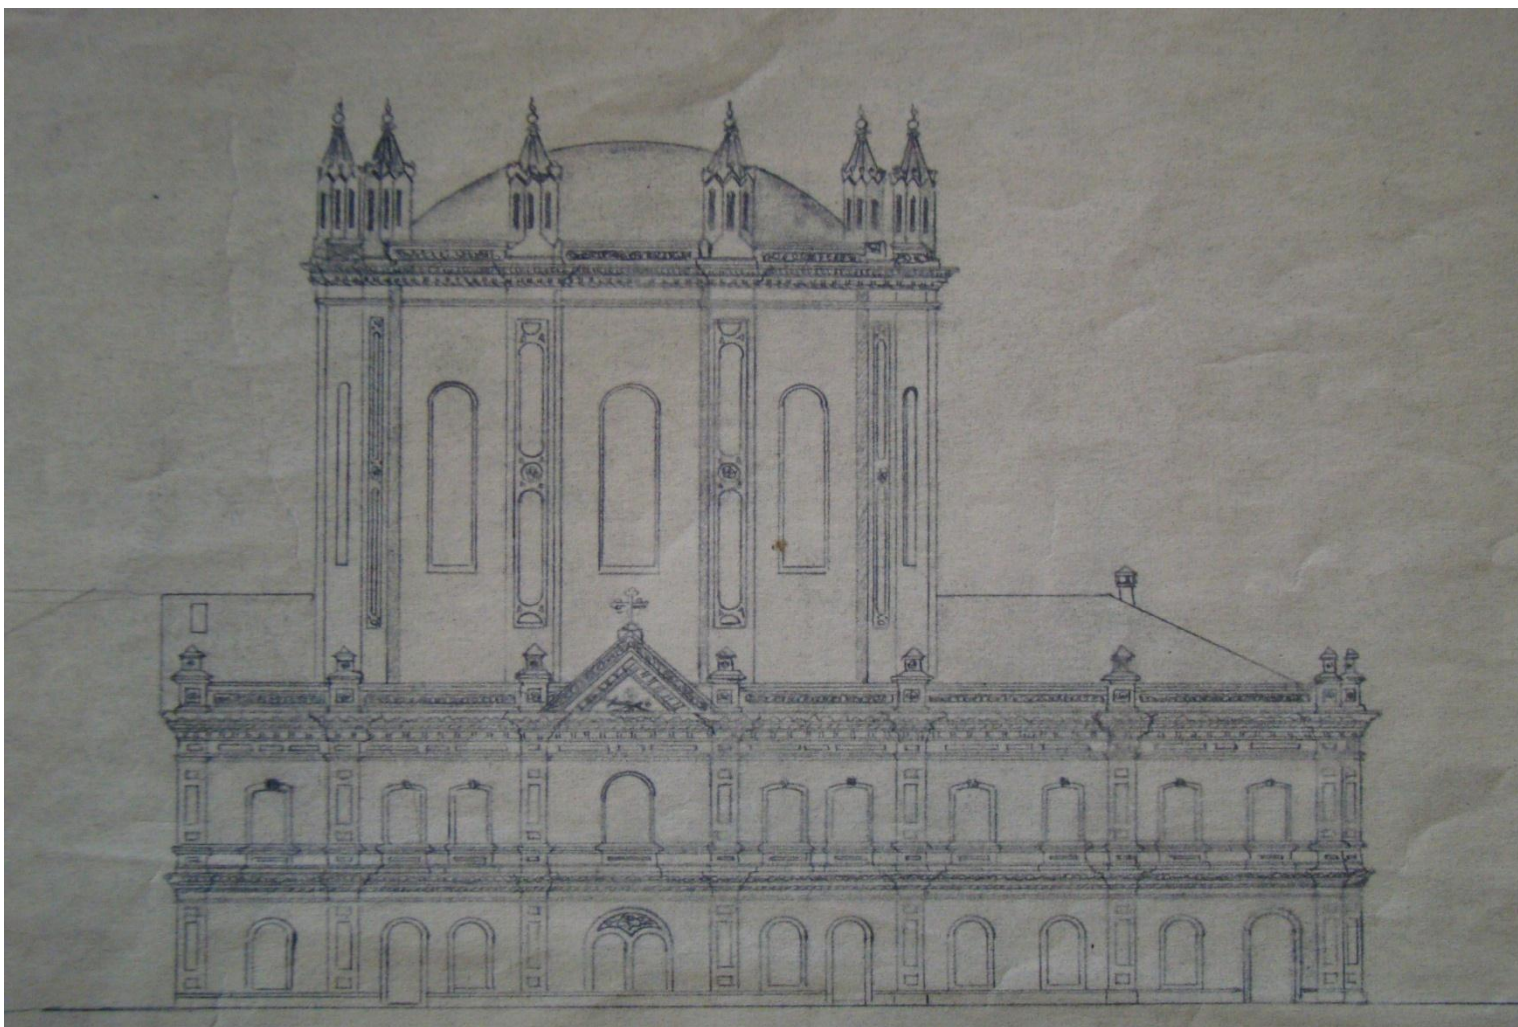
Fachada Posterior, Cubierta del Presbiterio
